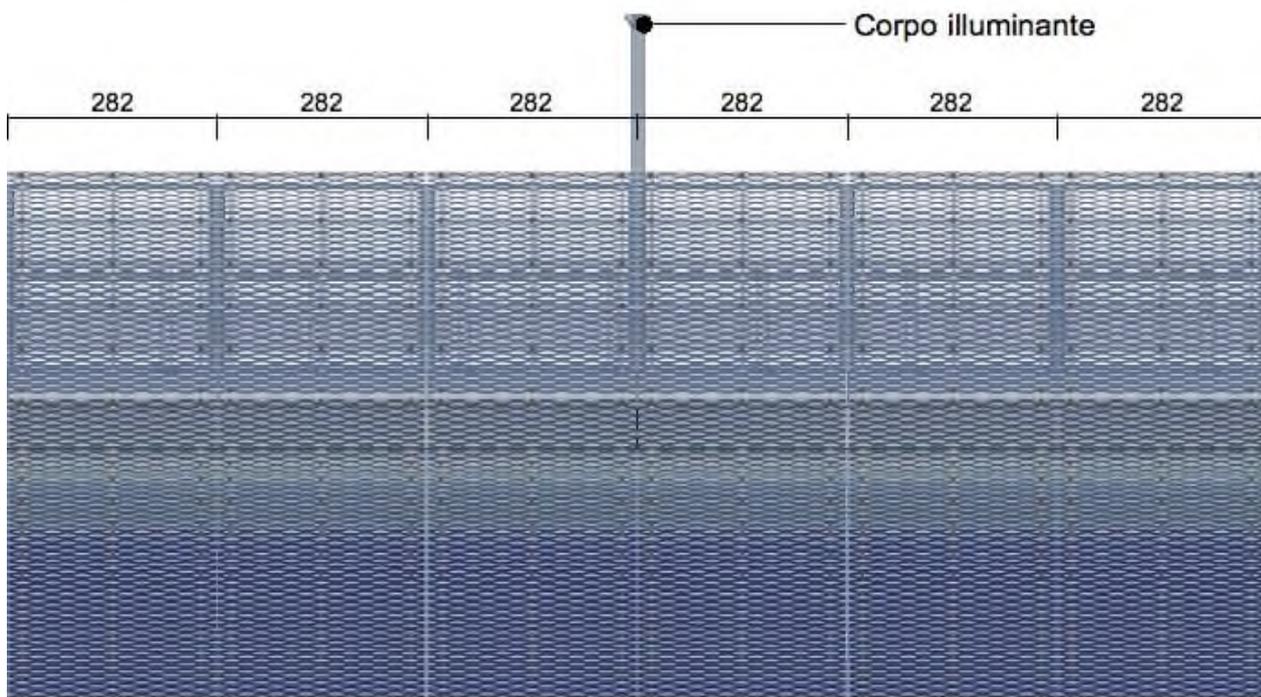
Barriera Esterna – Prospetto tipo – lato recettori.
